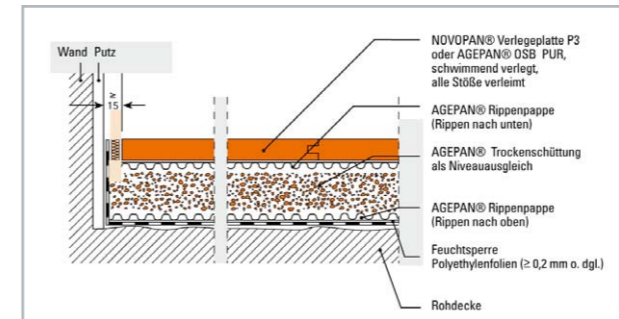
Das schwimmende Verlegen auf Stahlbetondecken mit AGEPAN® Trockenschüttung.
